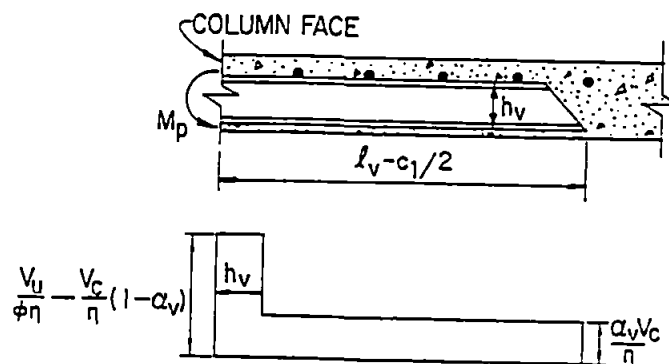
Corte idealizado que actúa en el conector de corte.
